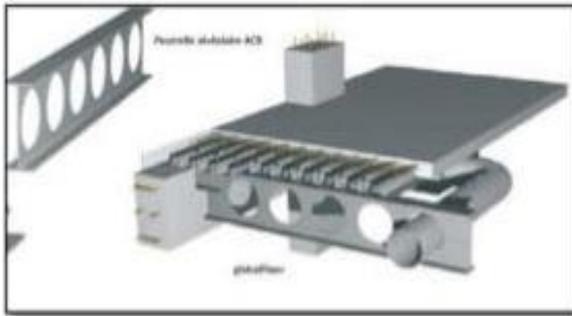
plancher collaborant avec des poutres alvéolaires. projet
